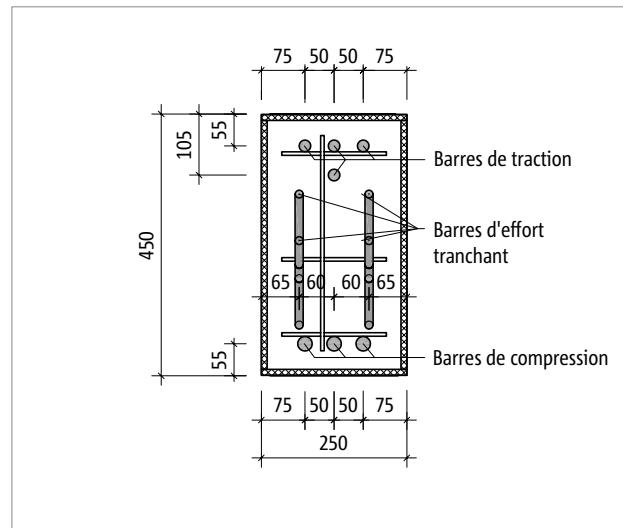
Schöck Isokorb® T Type B-M6-V2 en hauteur H450 : Vue du produit
